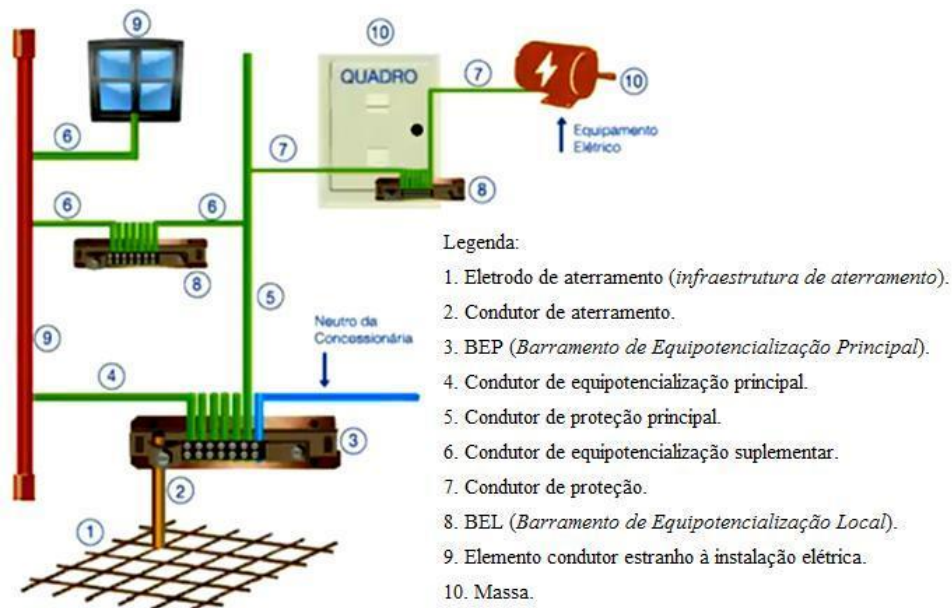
Instalação do sistema de aterramento de proteção das edificações. Fonte: [10].
